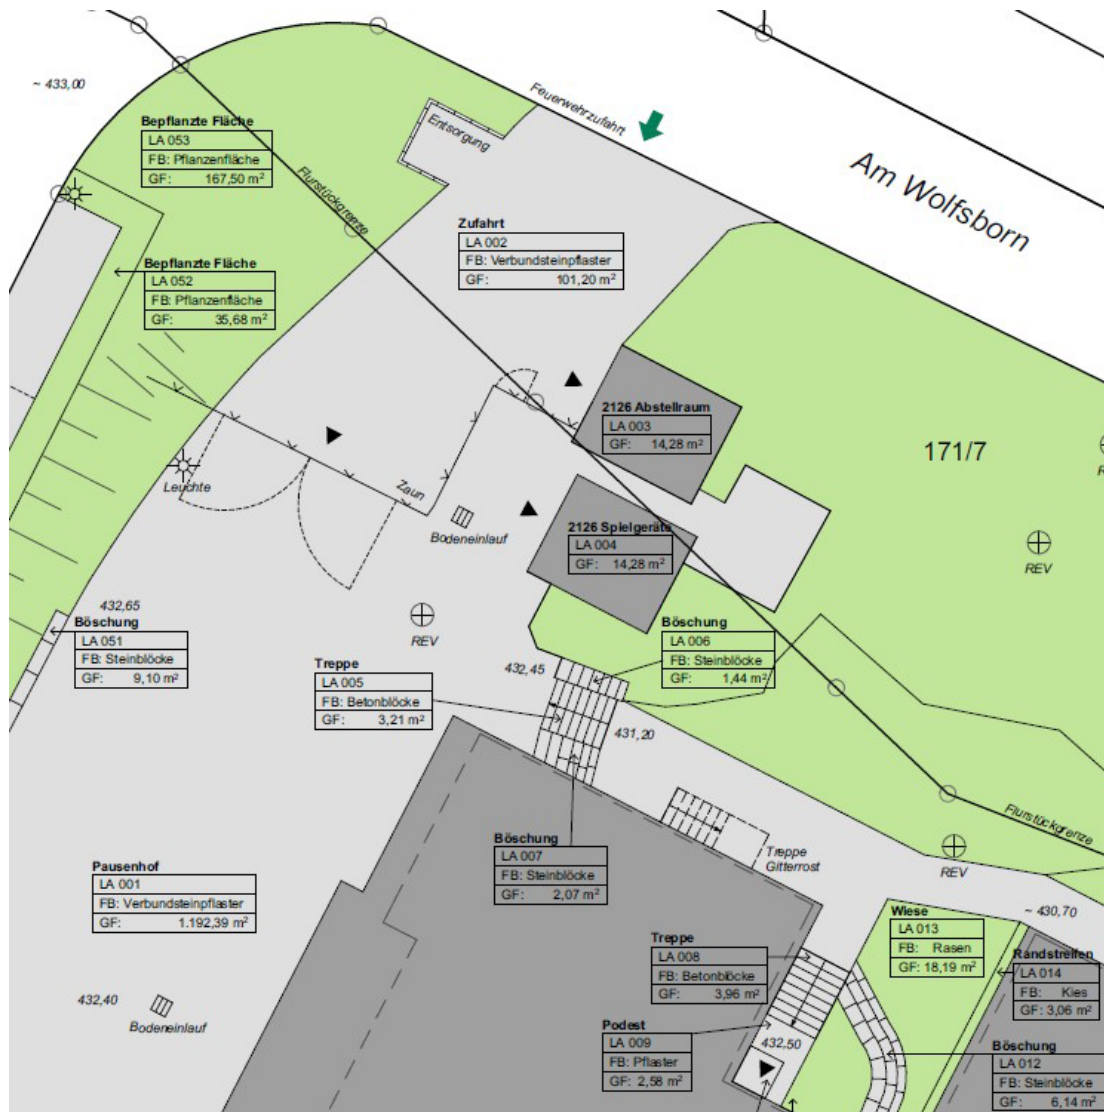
Lageplanausschnitt (Vergrößerung)
